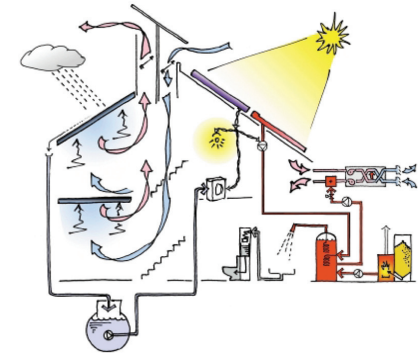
Schema in sezione sul funzionamento degli impianti; Fonte: www.kingspanlighthouse.com;
